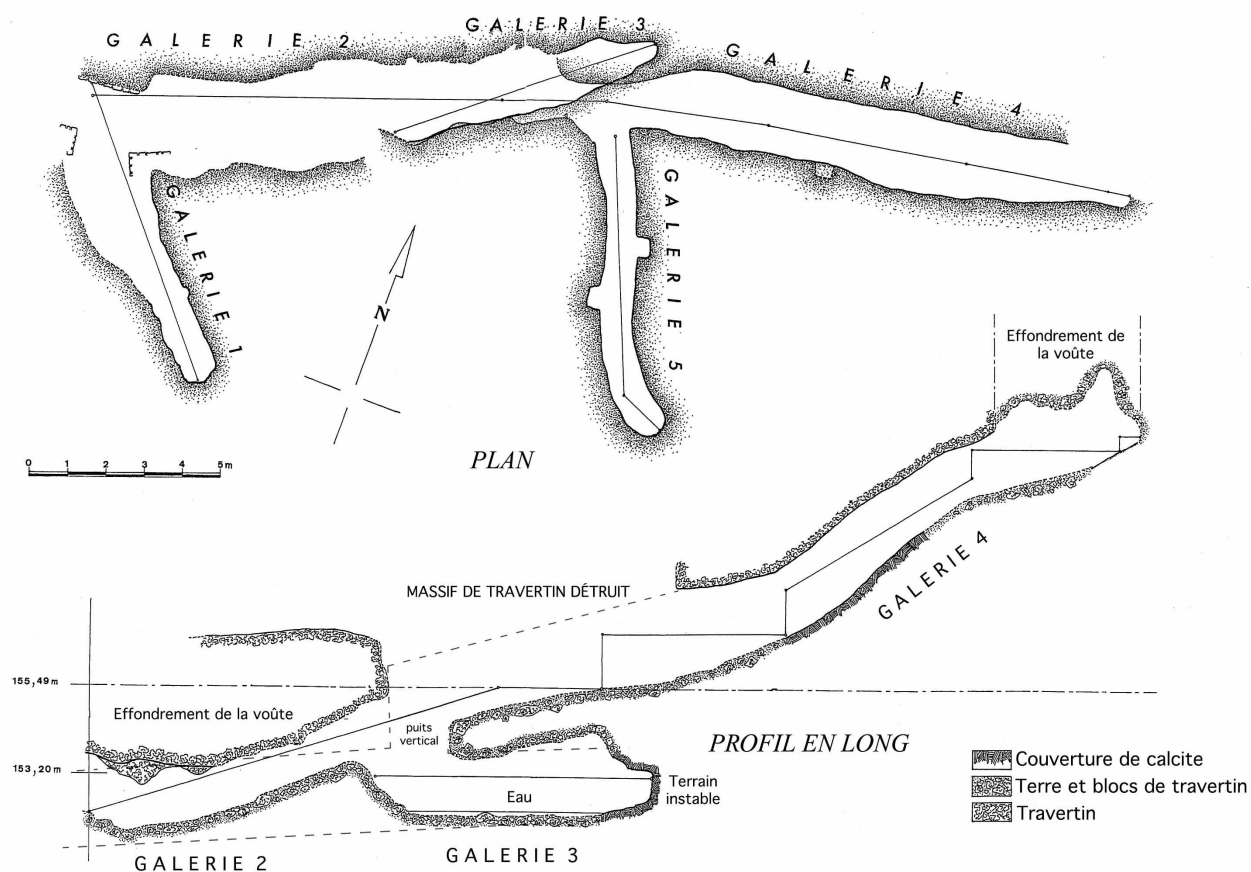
Réseau de galeries nord (G1 à G5) plan et profil en long.
